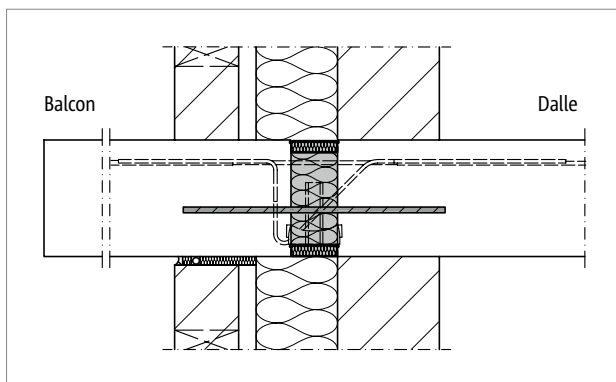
Schöck Isokorb® T Type H-NN : Avec T type K-E, K-T ; raccordement avec isolation du noyau
